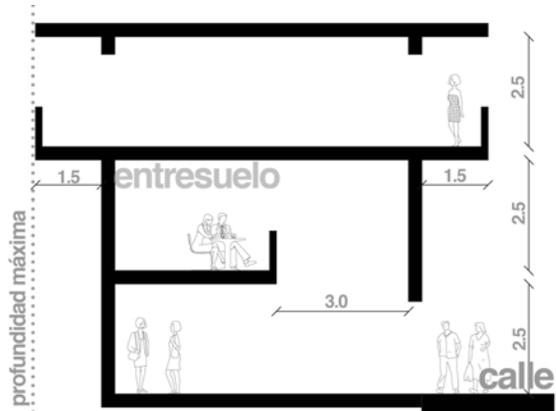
Diferenciación entre la planta baja y los entresuelos con la posibilidad de incluir un entresuelo. Fuente. PGM
